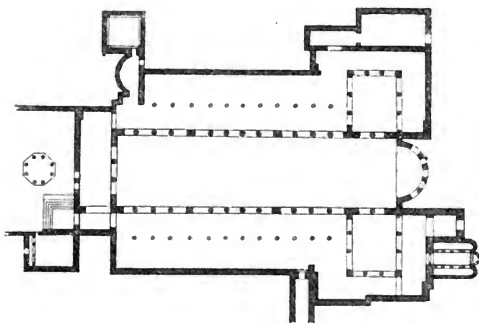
St. Demetrius in Thessalonich. Grundriss.
